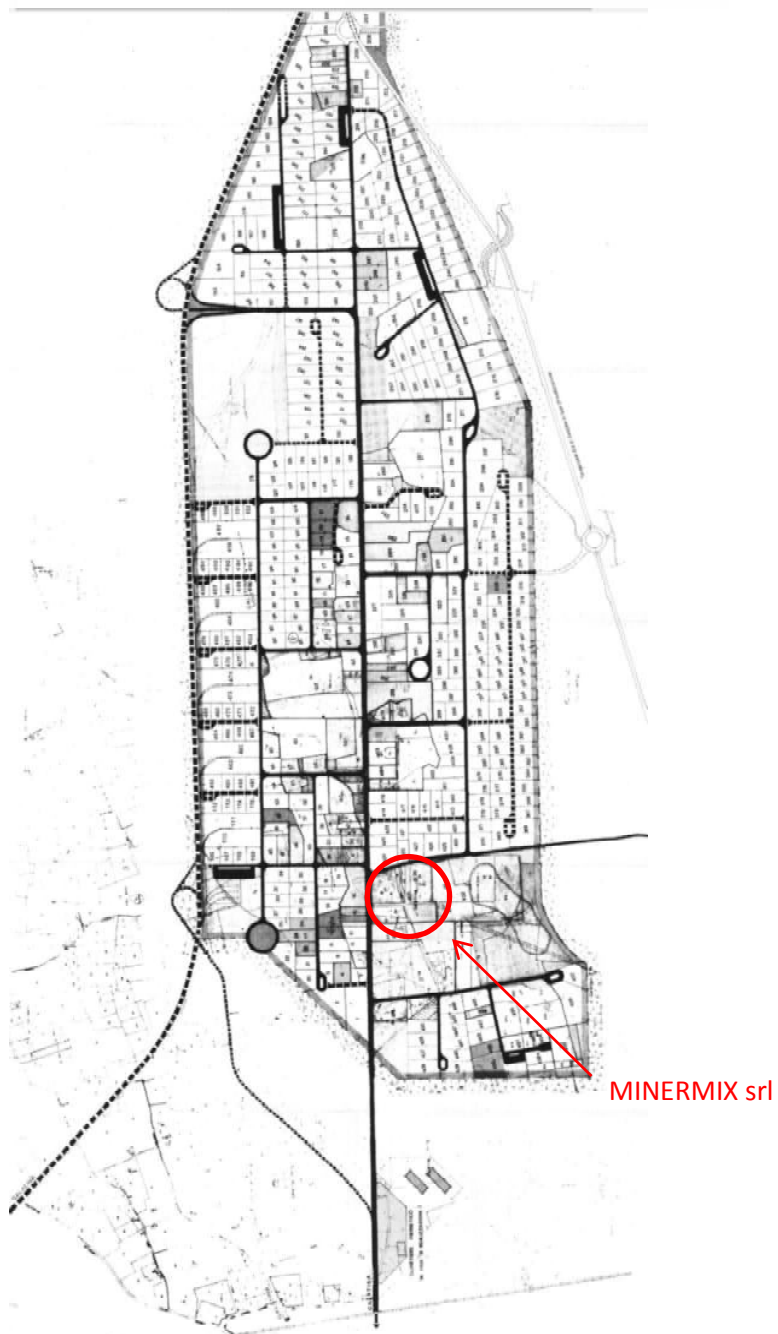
Stralcio piano di lottizzazione Zona Industriale "Galatina-Soletto" con indicazione dell'ubicazione dello stabilimento MINERMIX srl.
